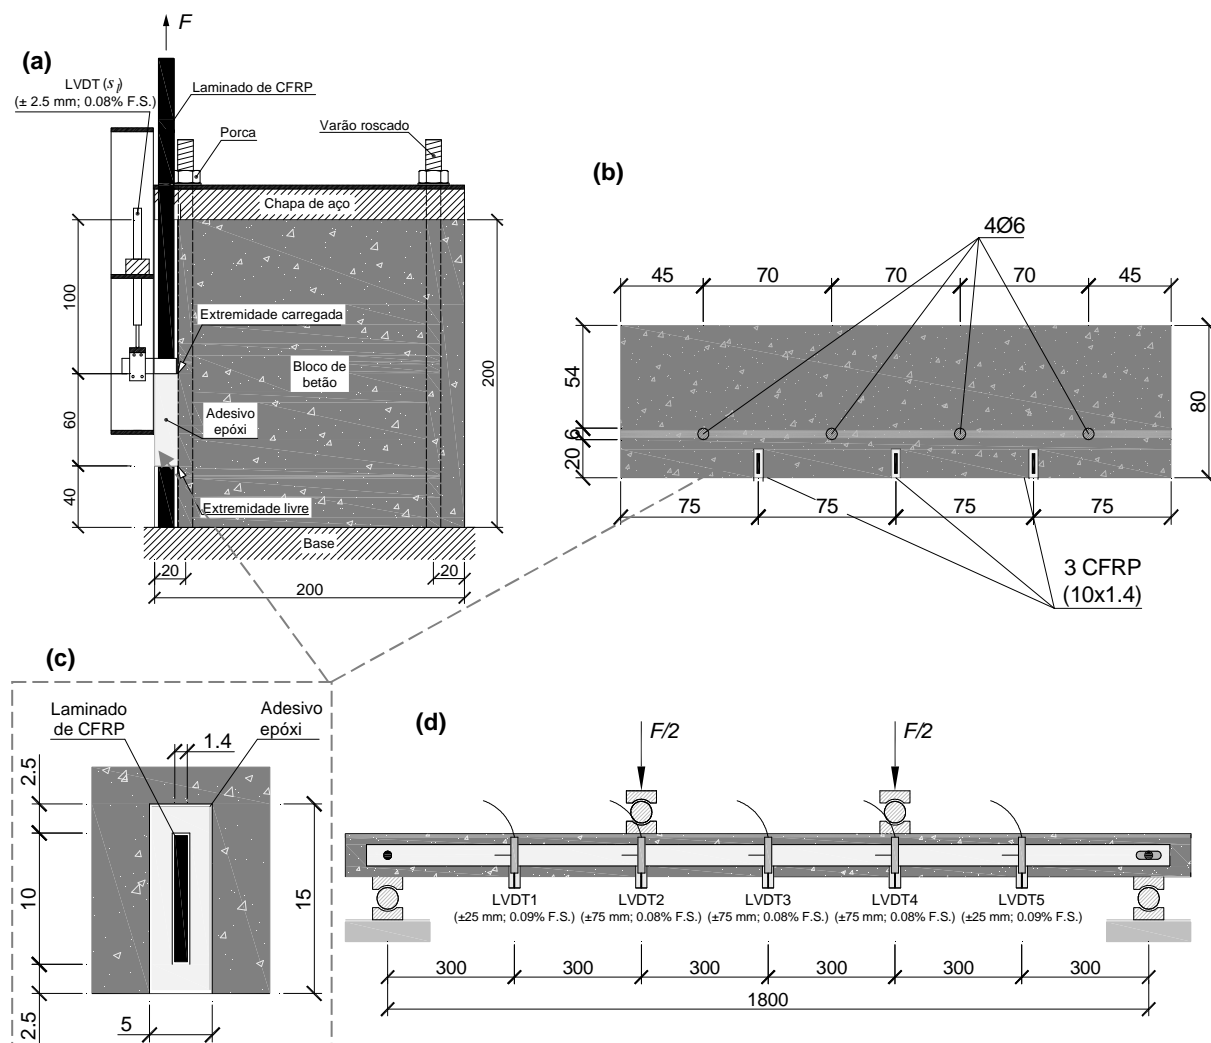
Configuração dos ensaios monotónicos à rotura: (a) ensaio de arranque direto; (b) secção transversal da laje; (c) detalhe do sistema de reforço; (d) ensaio à flexão da laje.
